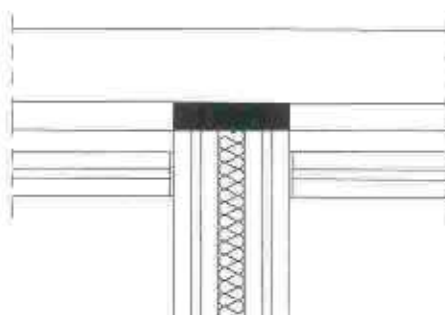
Encuentro desolidarizado de ESV-2 y fachada con complemento de plancha EEPS sustituyendo aislamiento no rígido
